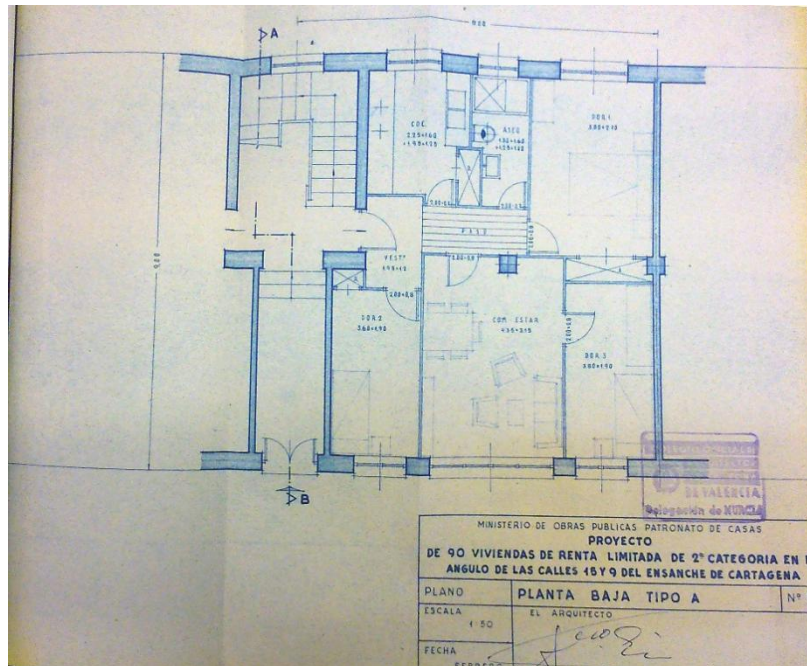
Plano de planta tipo A. [Fuente:Archivo Municipal de Cartagena]
